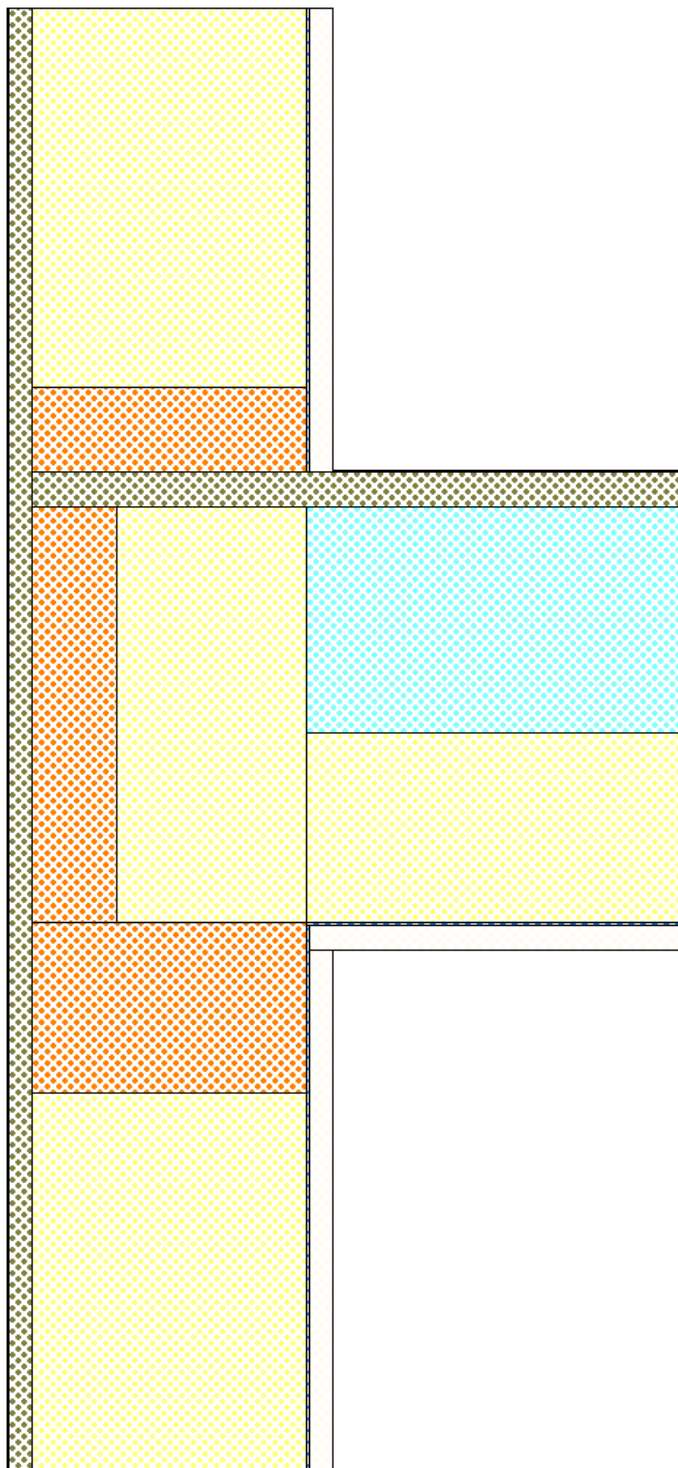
Configuration liaison plancher bois / mur à ossature bois
